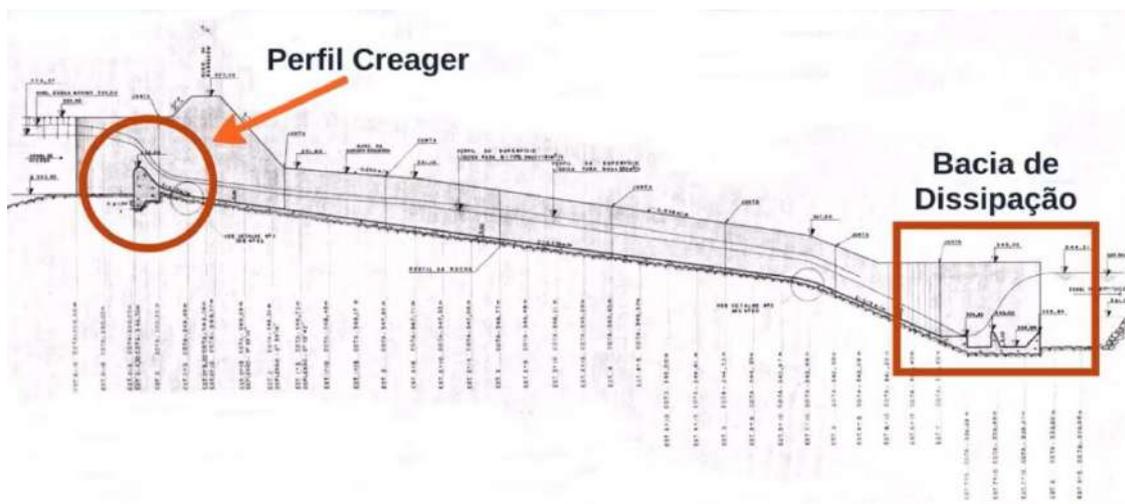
Corte "B" do Vertedouro – Perfil Creager e Bacia de Dissipação
